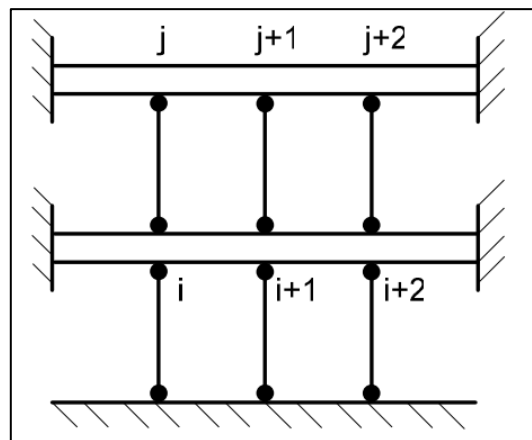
Estructura típica previa al desapuntado de la planta inferior
